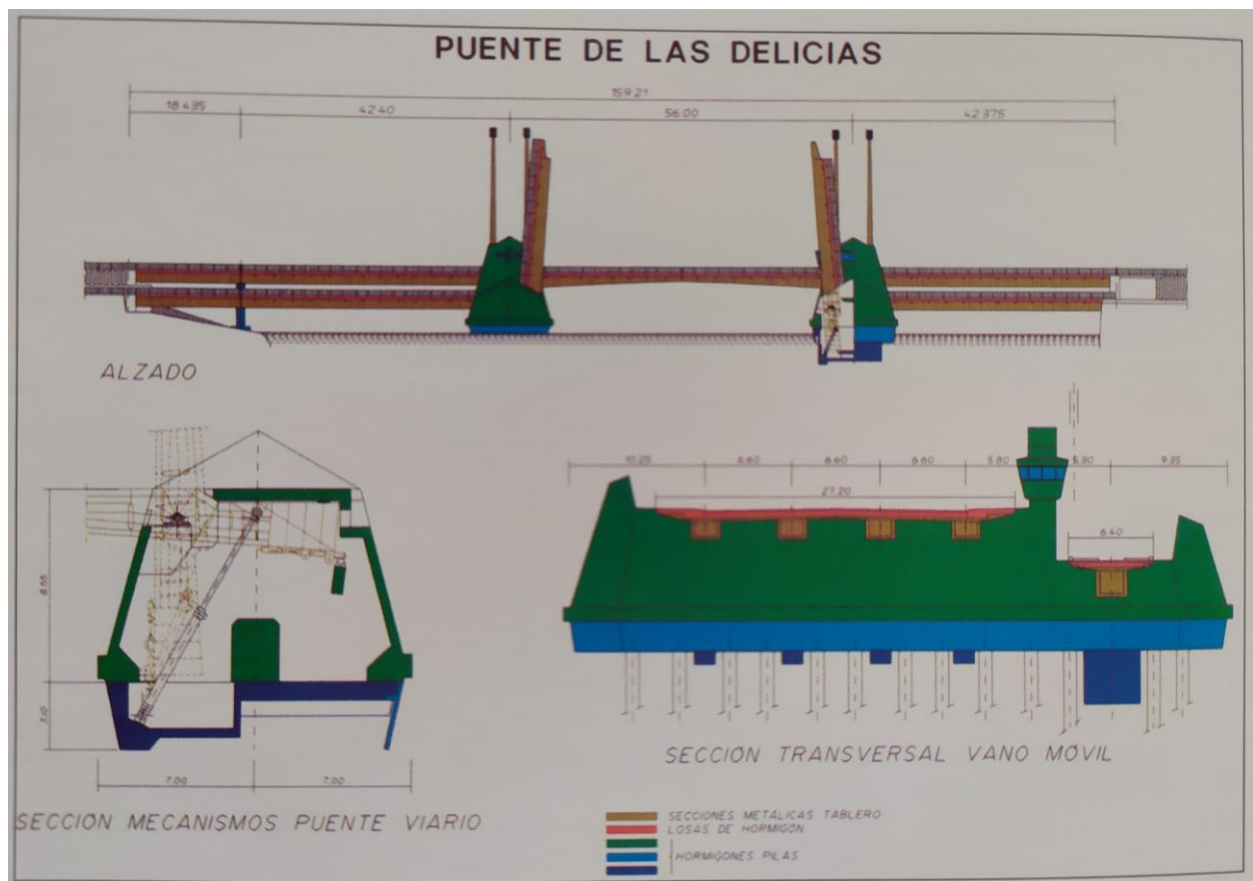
Alzado y secciones del puente. Fuente: Libro "Los puentes sobre el Guadalquivir en Sevilla".
